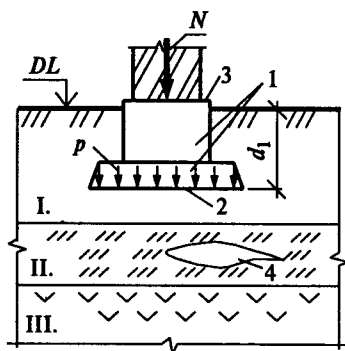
Основные понятия: 1 — фундамент; 2 — подошва фундамента; 3 — верхний обрез фундамента; 4 — линза (включение в пласт другого грунта); DL — отметка планировки;  $d_1$  — глубина заложения фундамента; I — несущий пласт; II, III — подстилающие пласты
